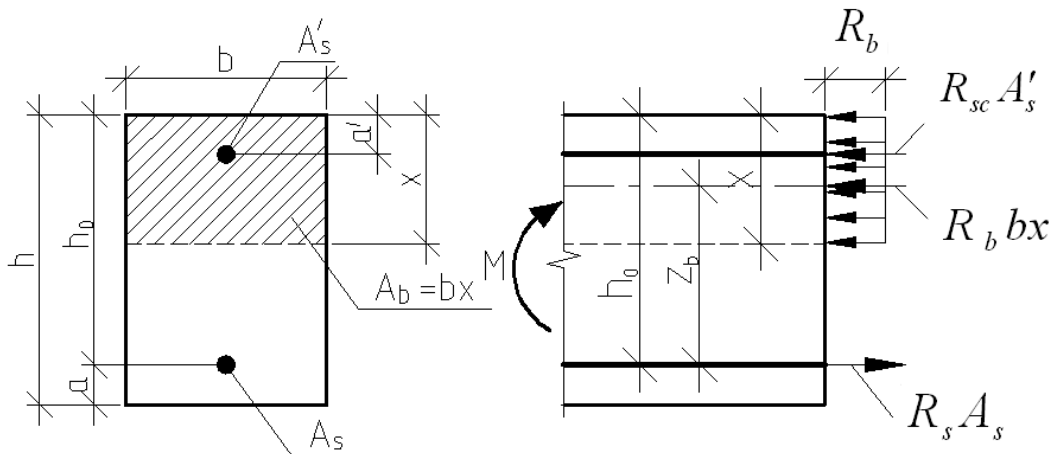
Прямоугольное сечение с двойной арматурой и схема усилий.
